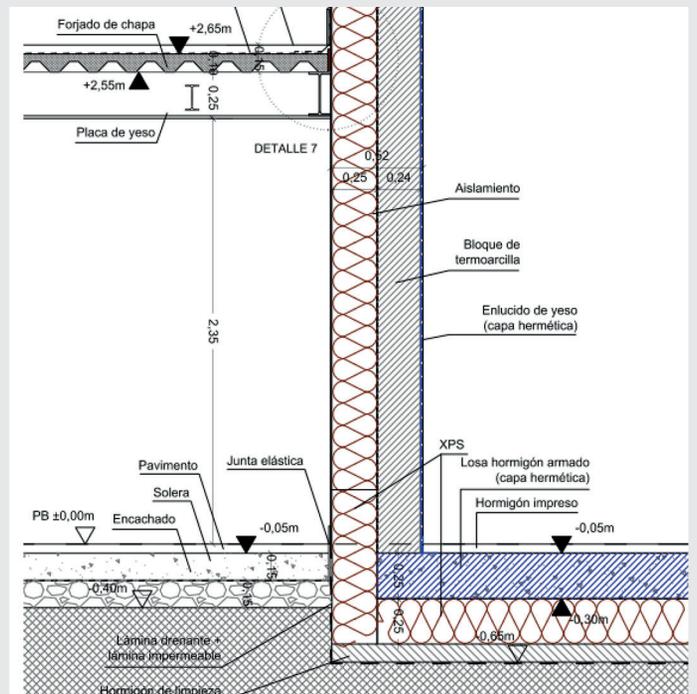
Detalle constructivo de proyecto. Encuentro Termoarcilla con losa y disposición del SATÉ asegurando la línea de aislamiento continua.
